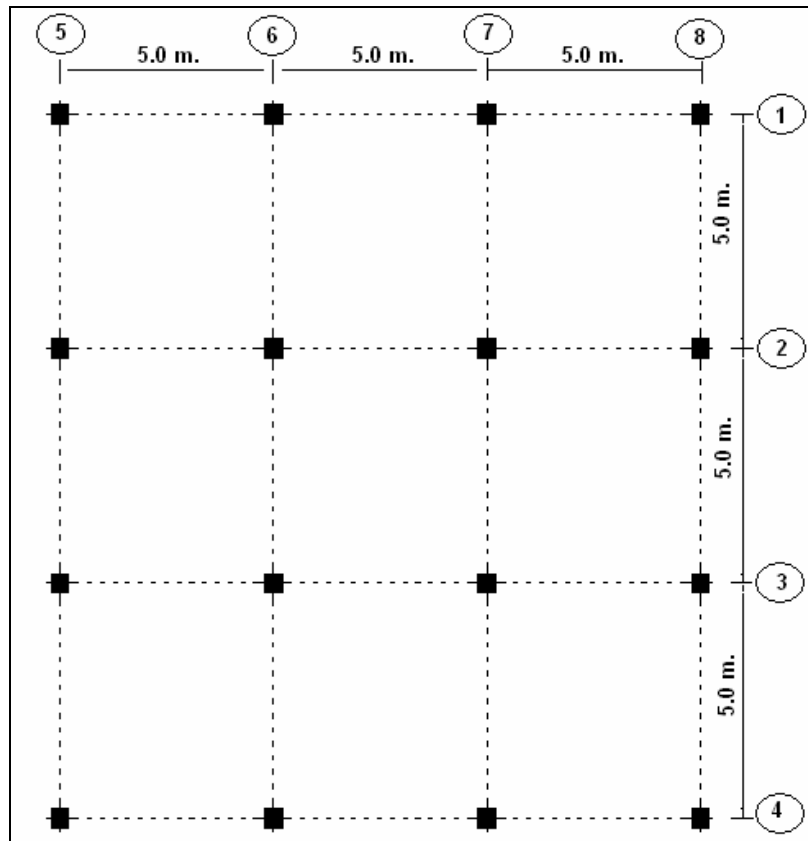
Distribución en planta de 54 estructuras analizadas de 1 a 6 pisos.
